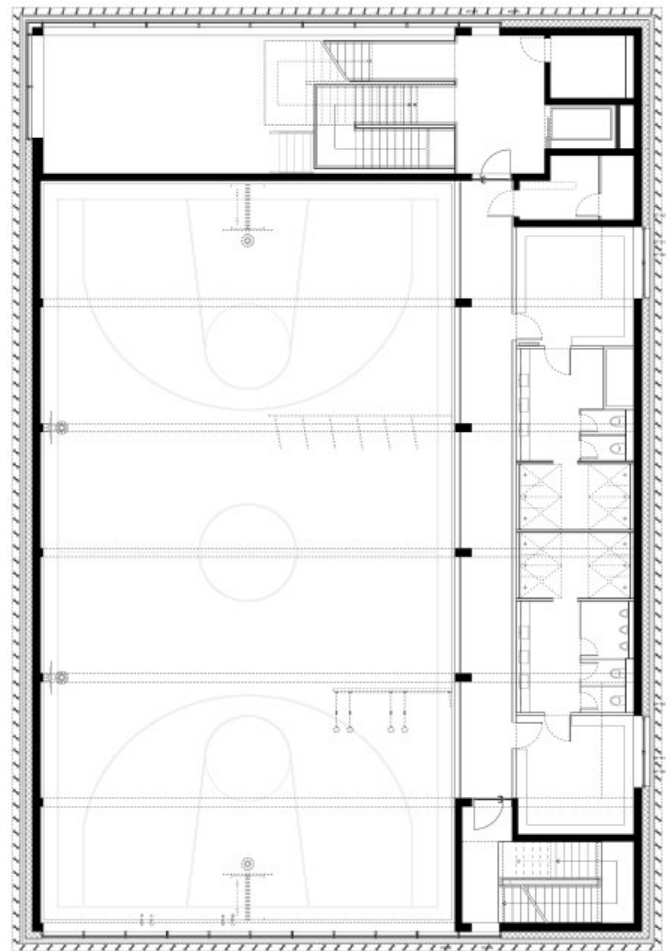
Grundriss 2. Obergeschoss: Regelgrundriss Galeriegesschoß
